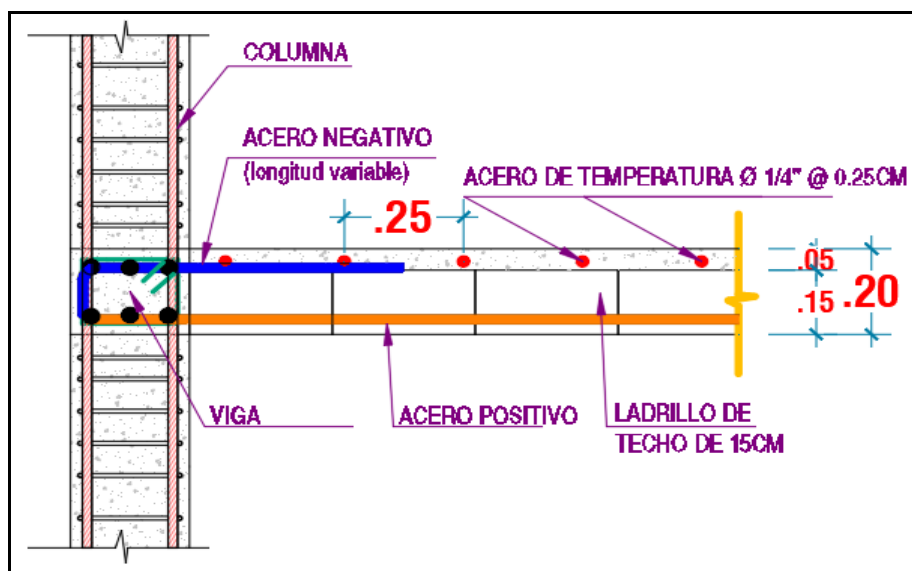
Detalle transversal de losa aligerada. Elaboración propia
